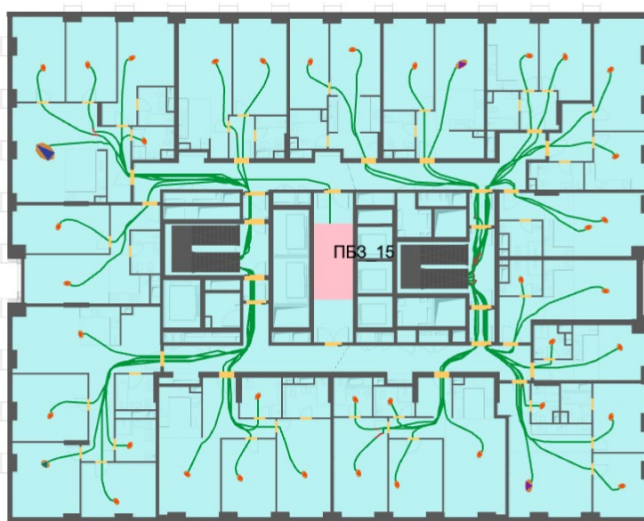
План 15-го – 31-го этажа и нанесенная на него расчетная (принципиальная) схема эвакуации
